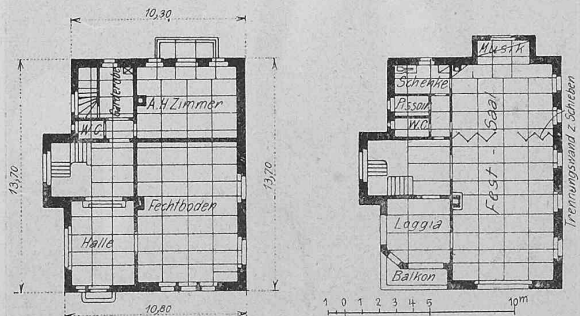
Grundrisse vom Erdgeschoss und ersten Obergeschoss. — 1 : 400.
